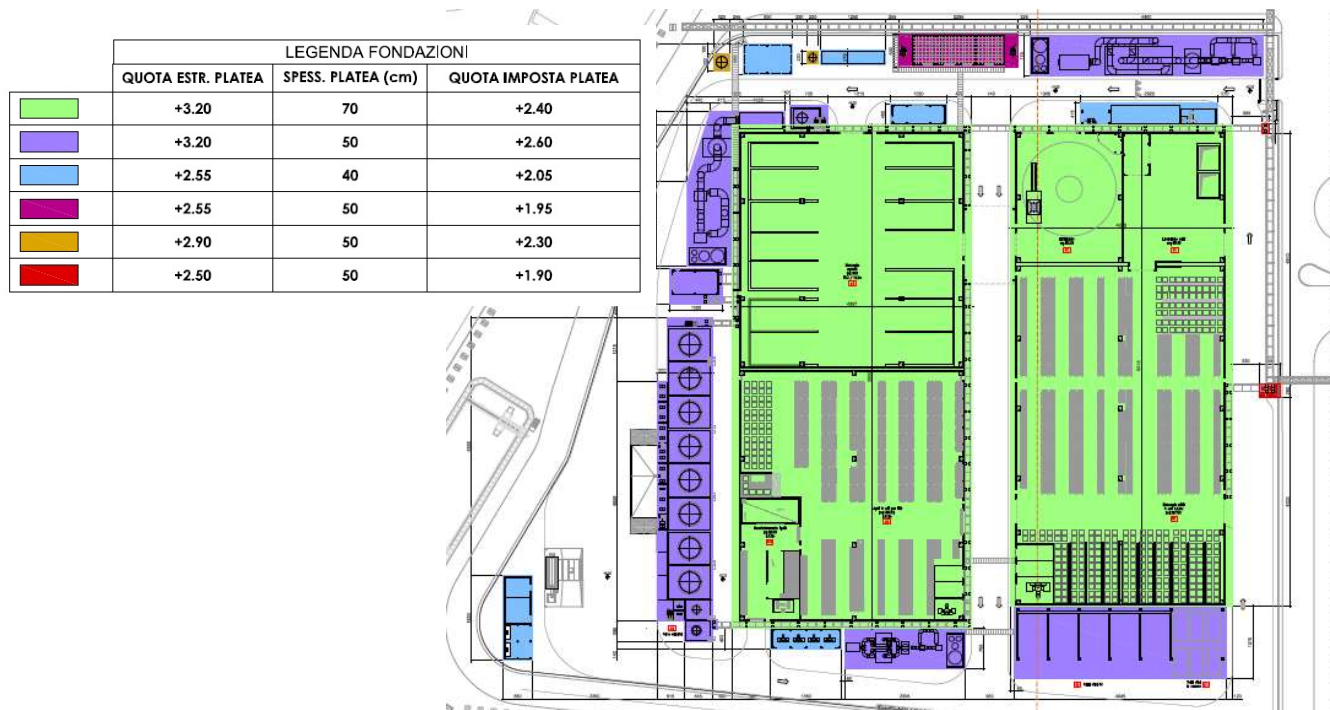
Stralcio planimetria fondazioni [cod. doc. EI.38.00_CO 05 RA VA 00 D1 PL 38.00 - PLANIMETRIA FONDAZIONI]
